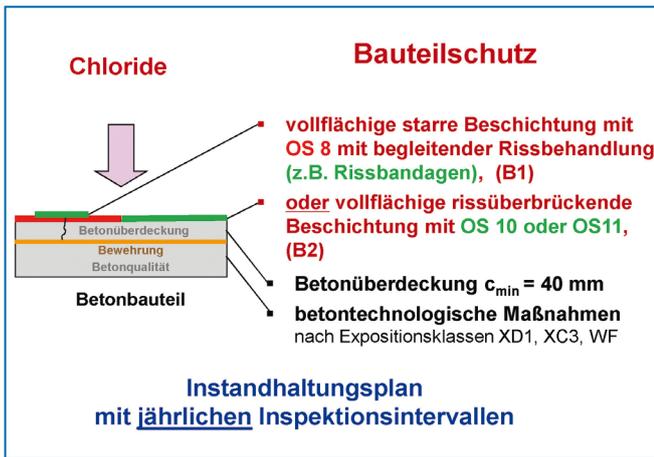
Planungsvariante B: Schutz des Betonbauteils durch eine flächige Beschichtung mit einem Oberflächenschutzsystem nach RL SIB
